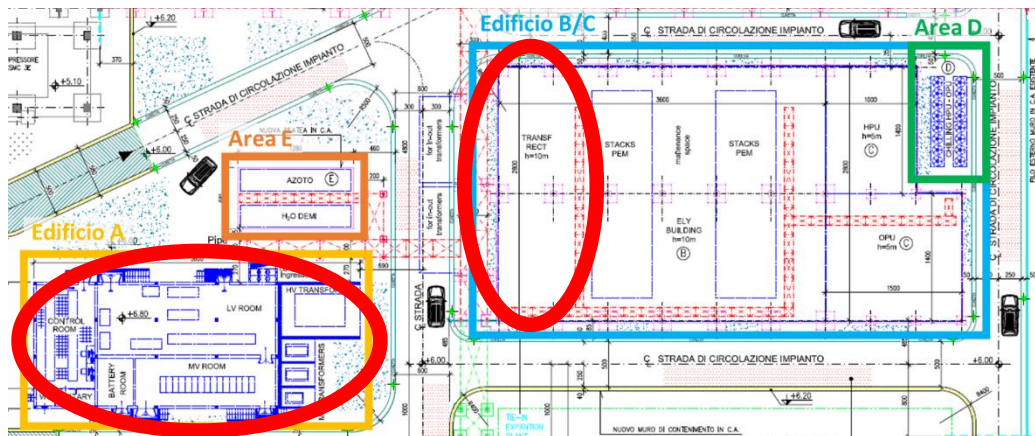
Layout dell'impianto – particolare alimentazione e distribuzione elettrica
